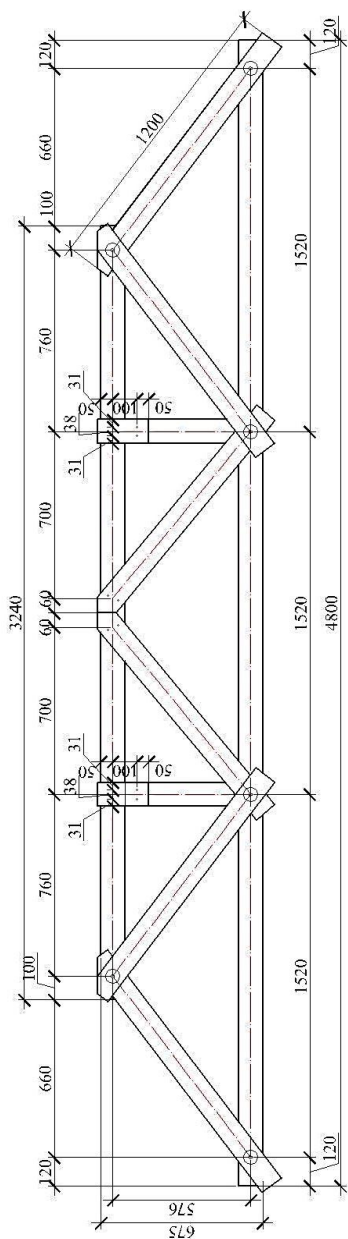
Деталировочный чертеж испытываемой фермы
